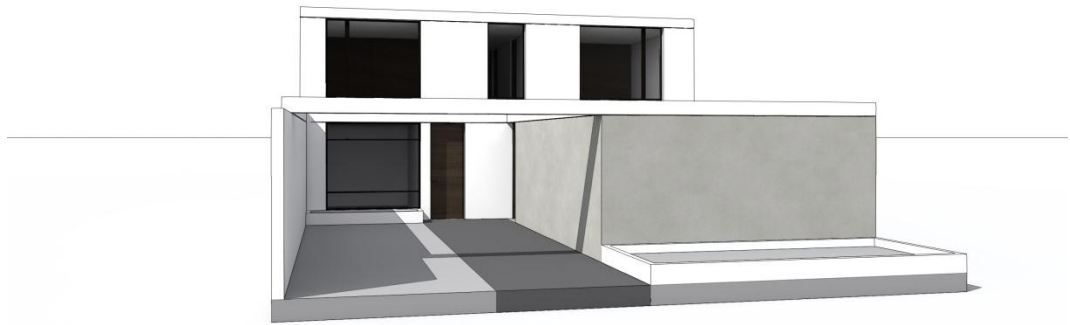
Vista 3d, fachada principal Fuente: Elaboración propia.
